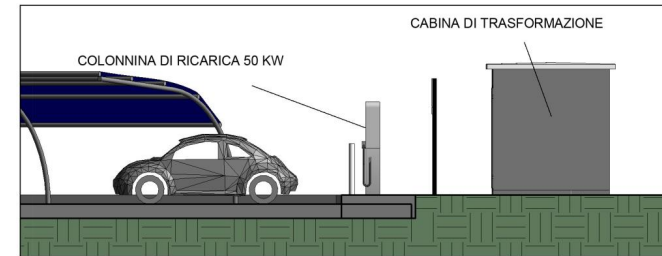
Area di Servizio La Pioppa ovest - Pianta
